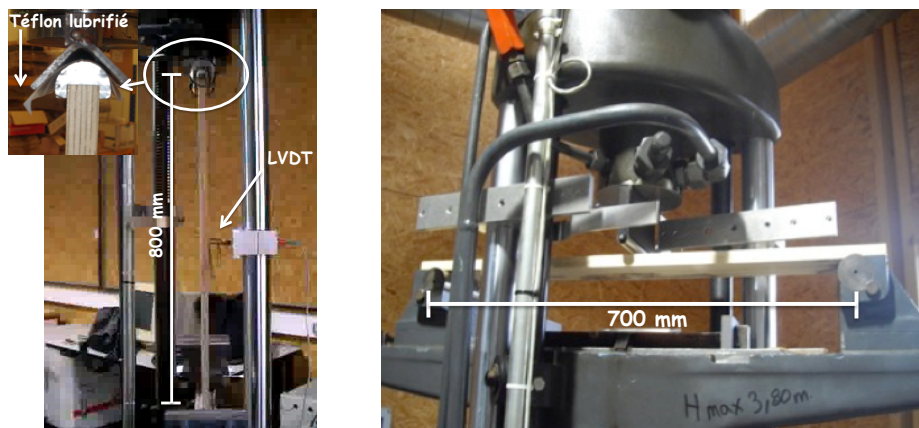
Dispositifs de flambement et de flexion 3 points sur des éprouvettes de LVL.
